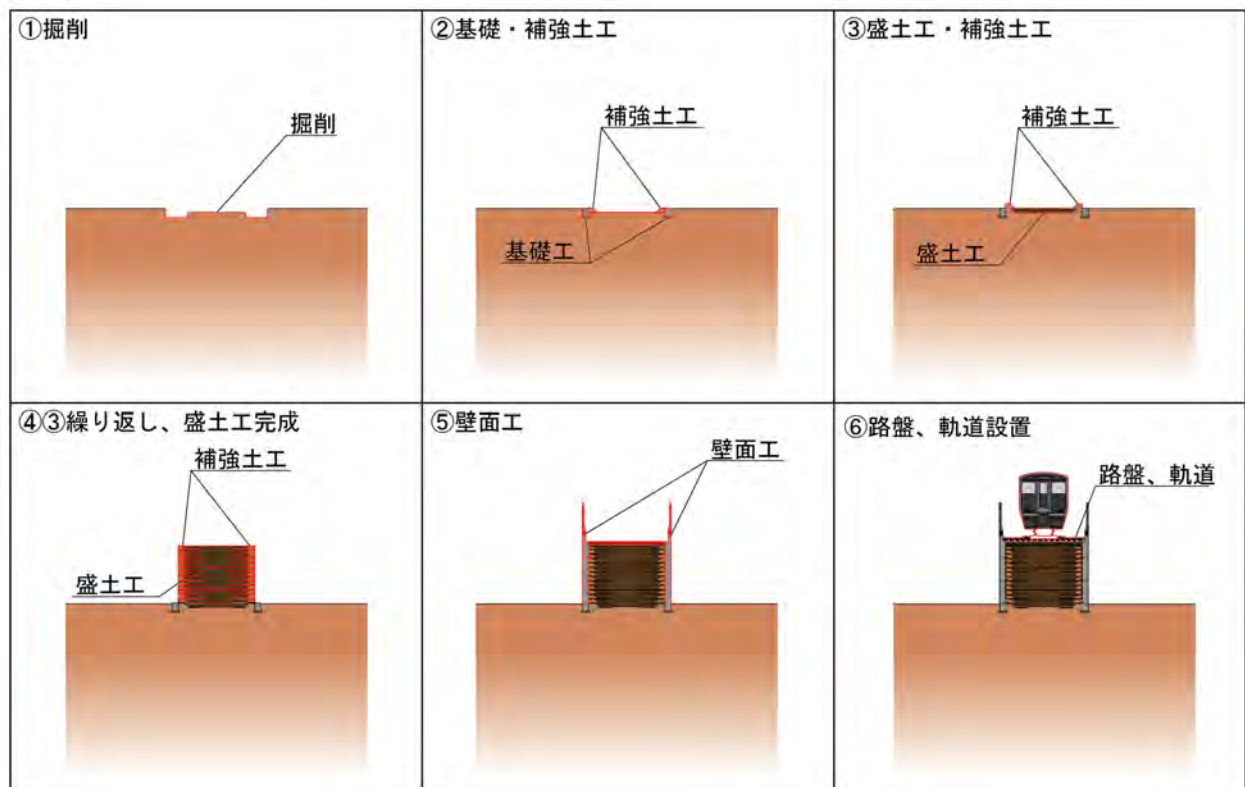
施工ステップ図（盛土工事（補強土工））
